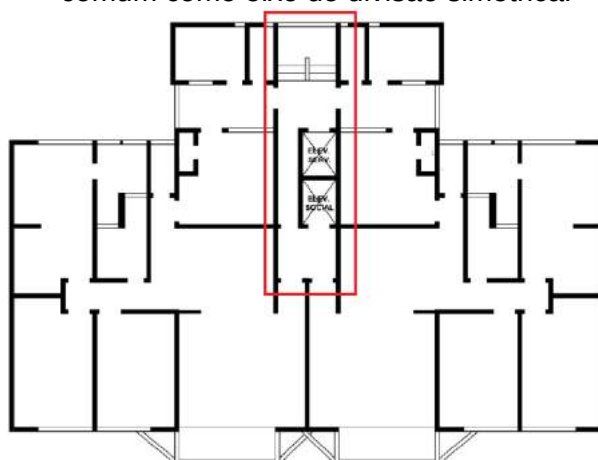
Planta do pavimento do edf. Barroca, com escada confinada interiorizada.
